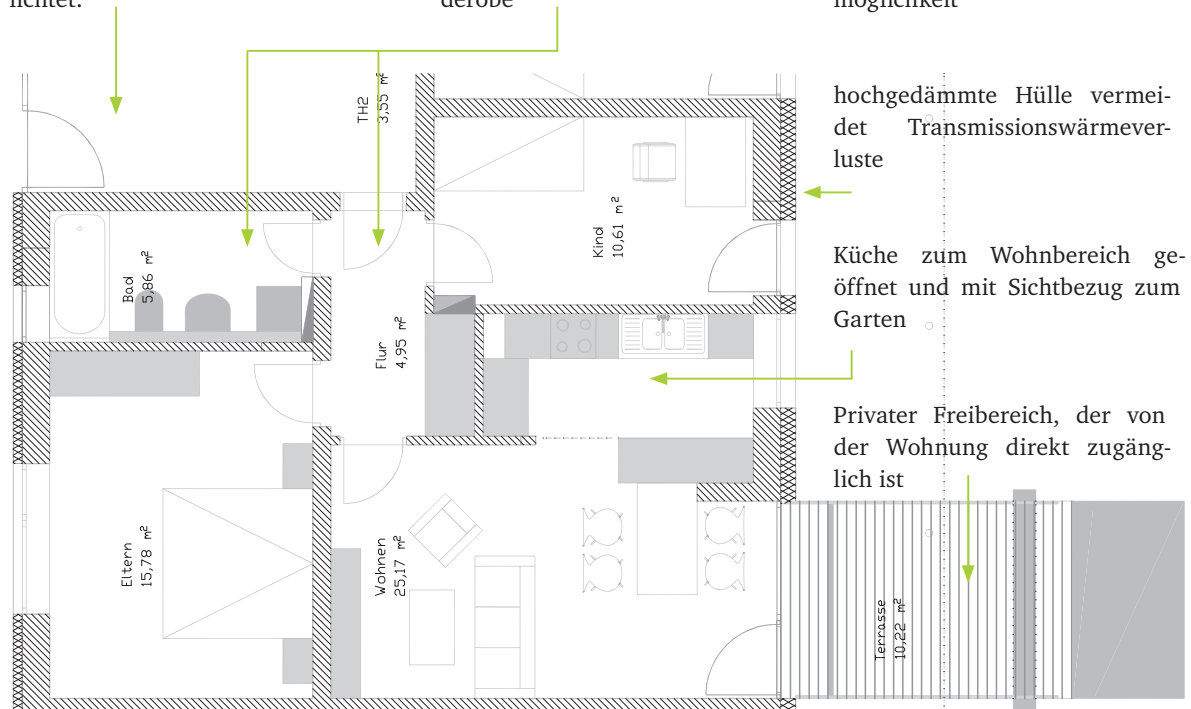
Grundriss o. M., Grafik: Architekturbüro Reiszky
